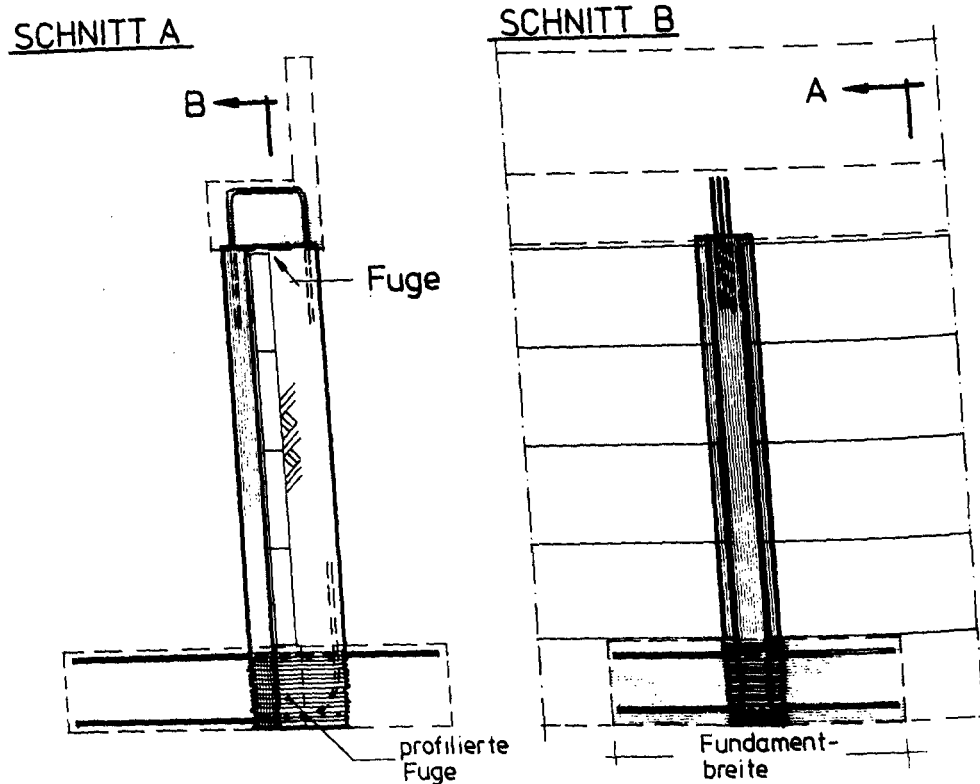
Fundament- und Auflagerbalkenanschluß einer Fertigteilrippe
